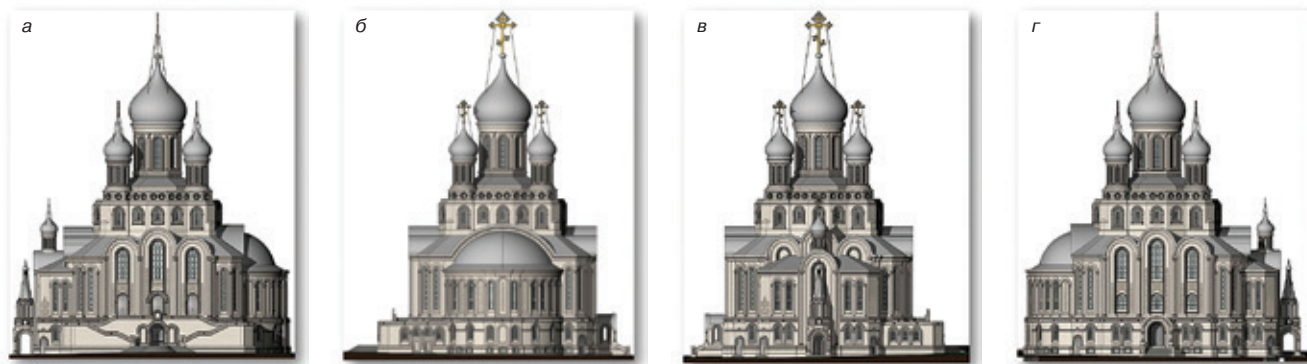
3D-модель: а – южный фасад; б – восточный фасад; в – западный фасад; г – северный фасад
